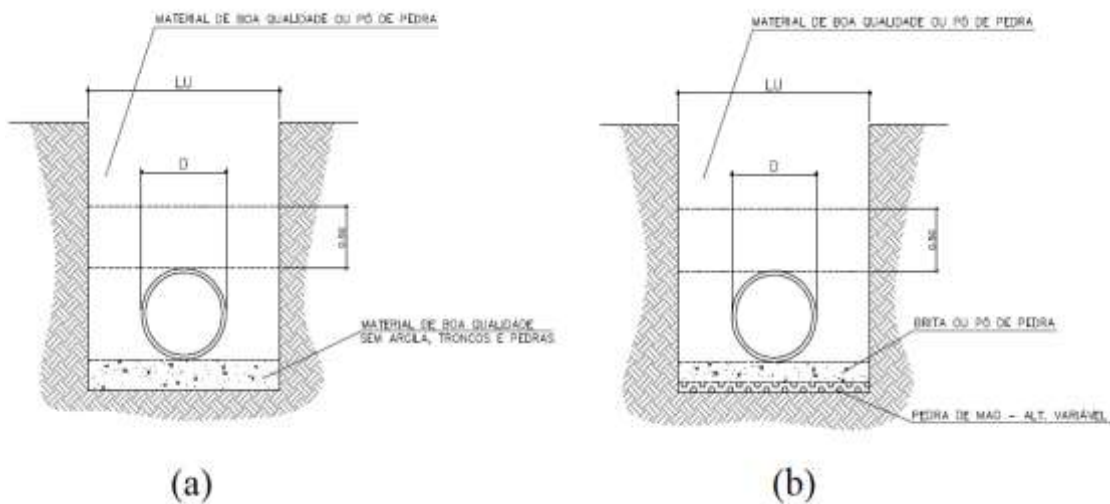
Detalhe construtivo para execução de embasamento.
